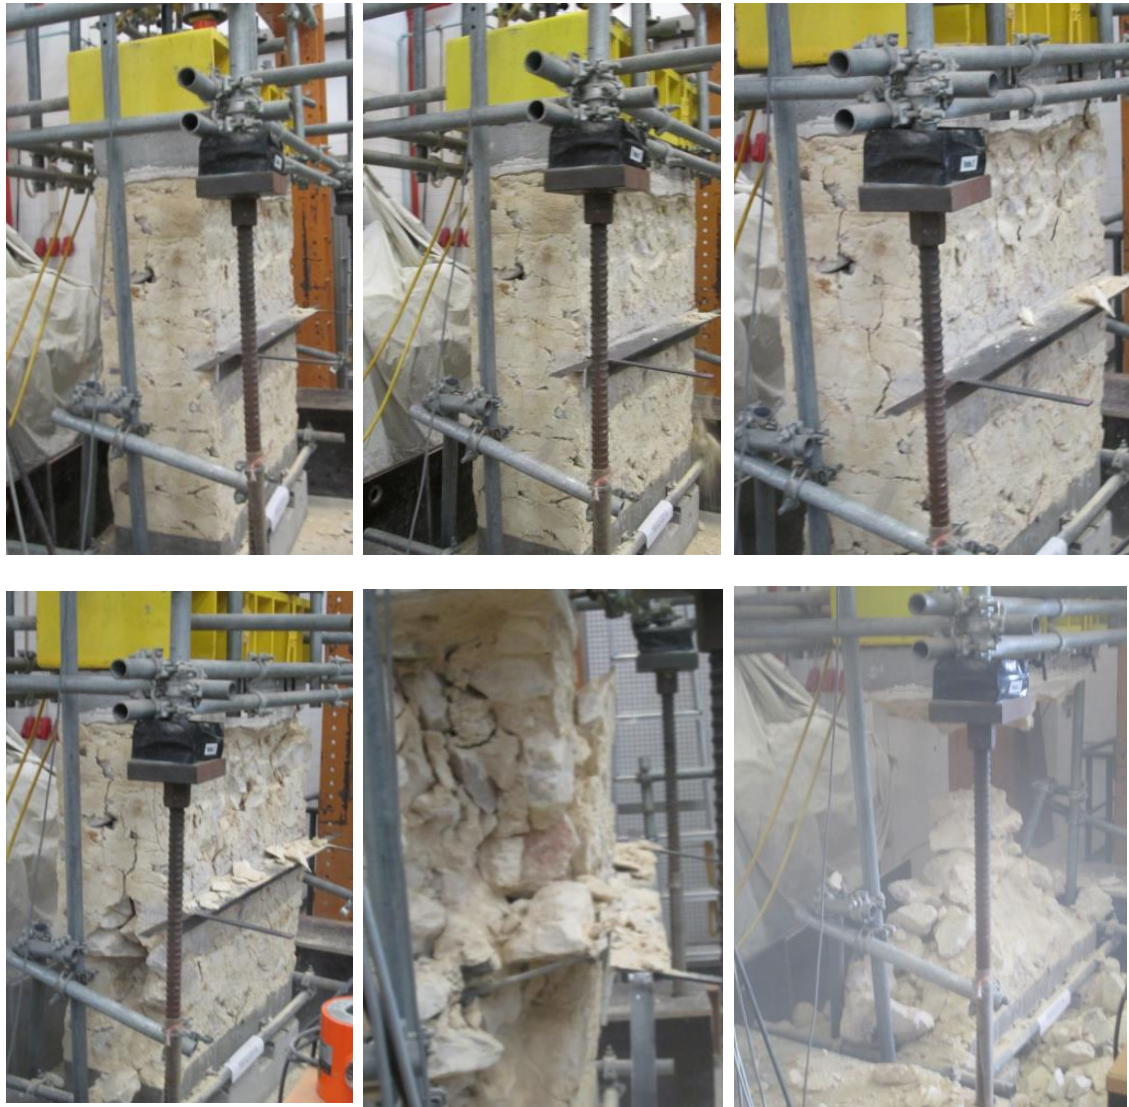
Ensaio de compressão sobre o murete m15.
